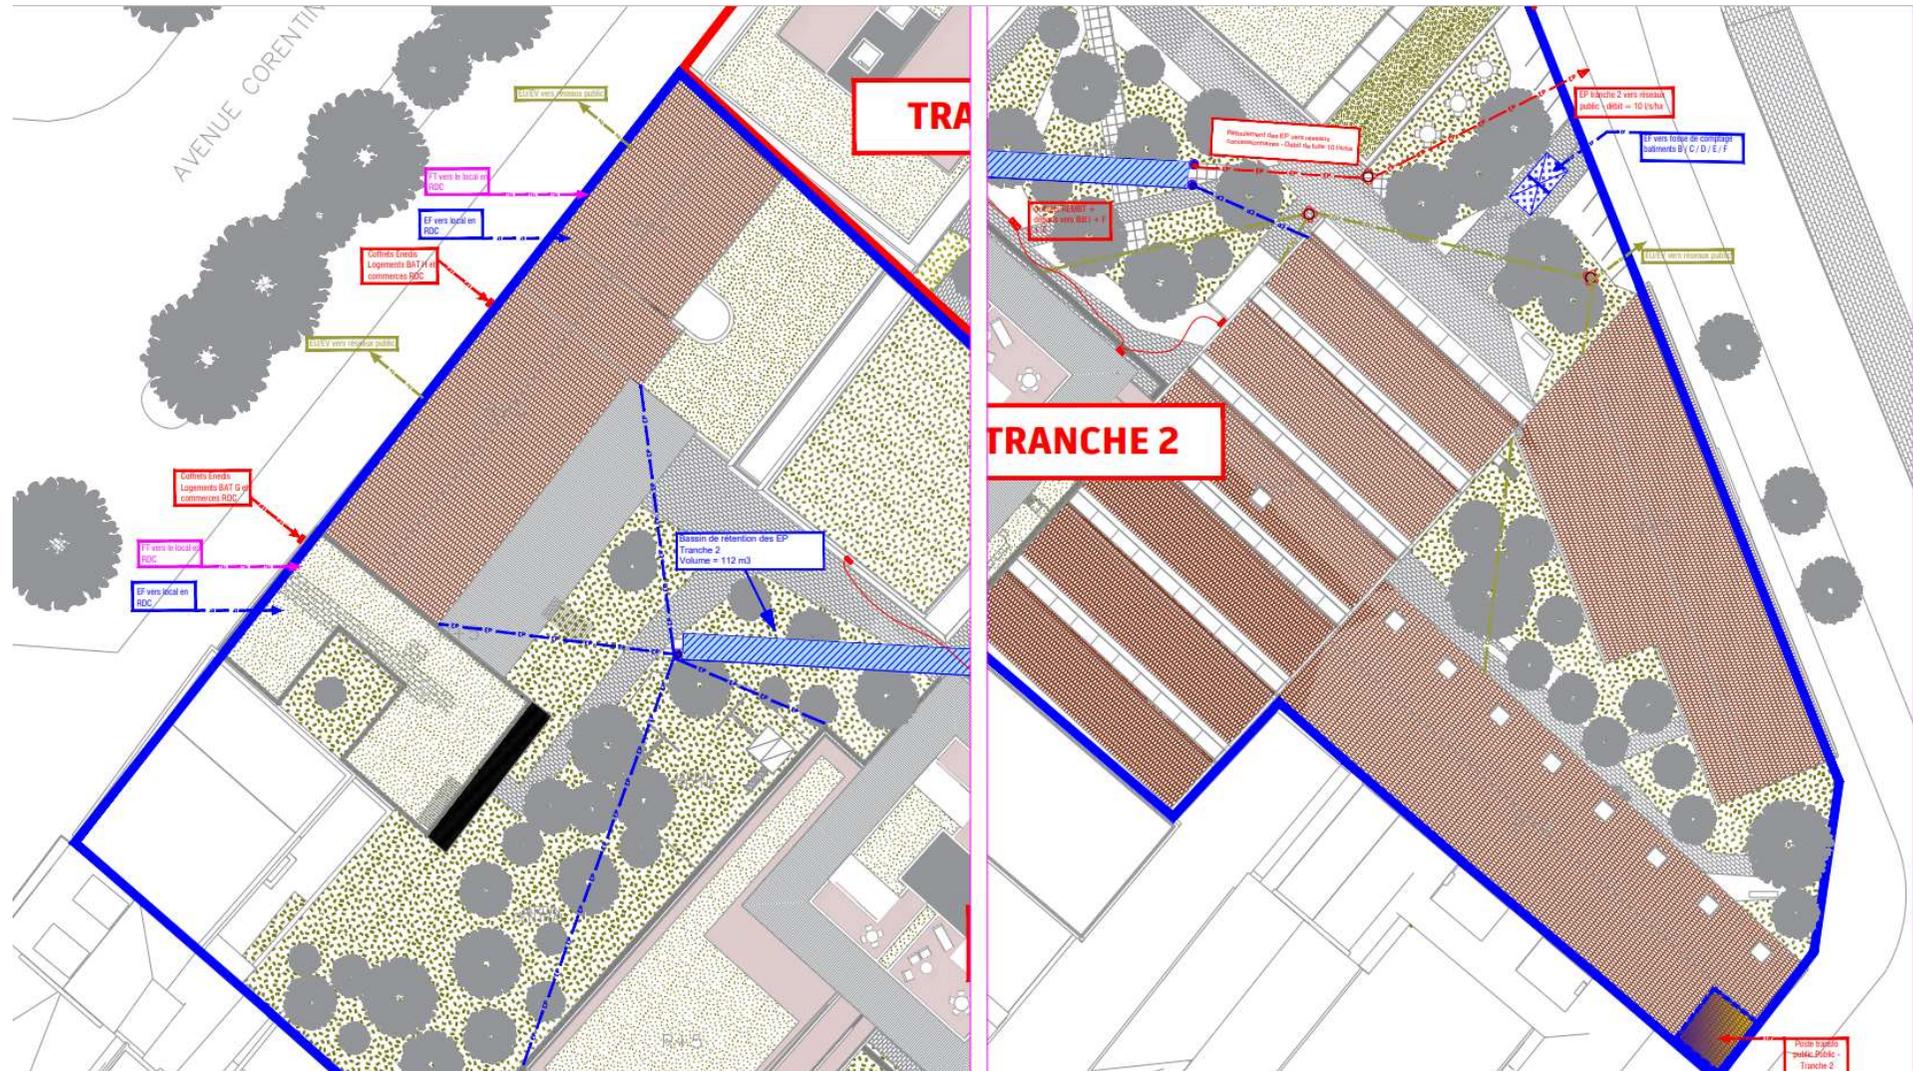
Plan VRD sur tranche 2 : Source : SODEBA GINKO
